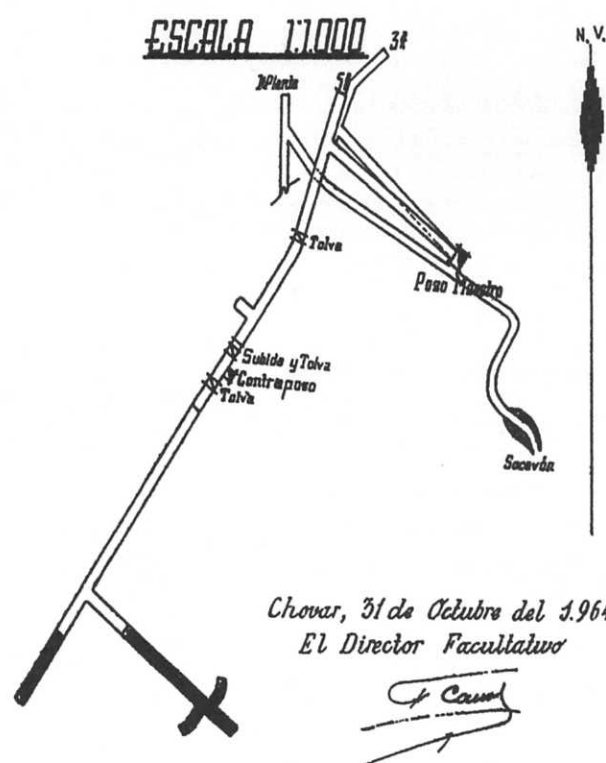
Plano de la Mina San Francisco, Chóvar (Castelló). Proyección horizontal.
